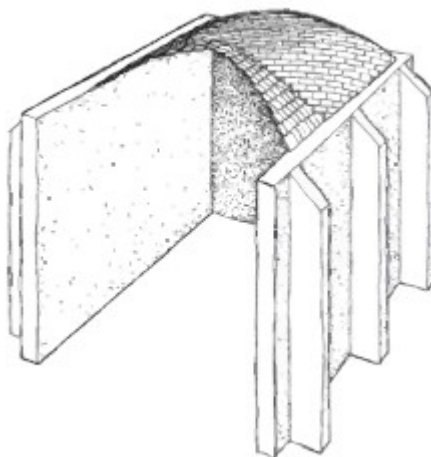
Mexická klenba zděná z rohů nad čtvercovým půdorysem [6]
